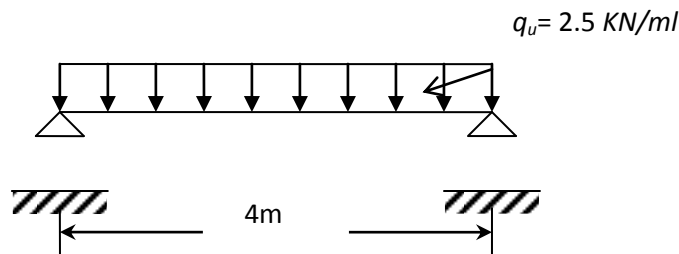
Schéma de calcul de la poutrelle.
